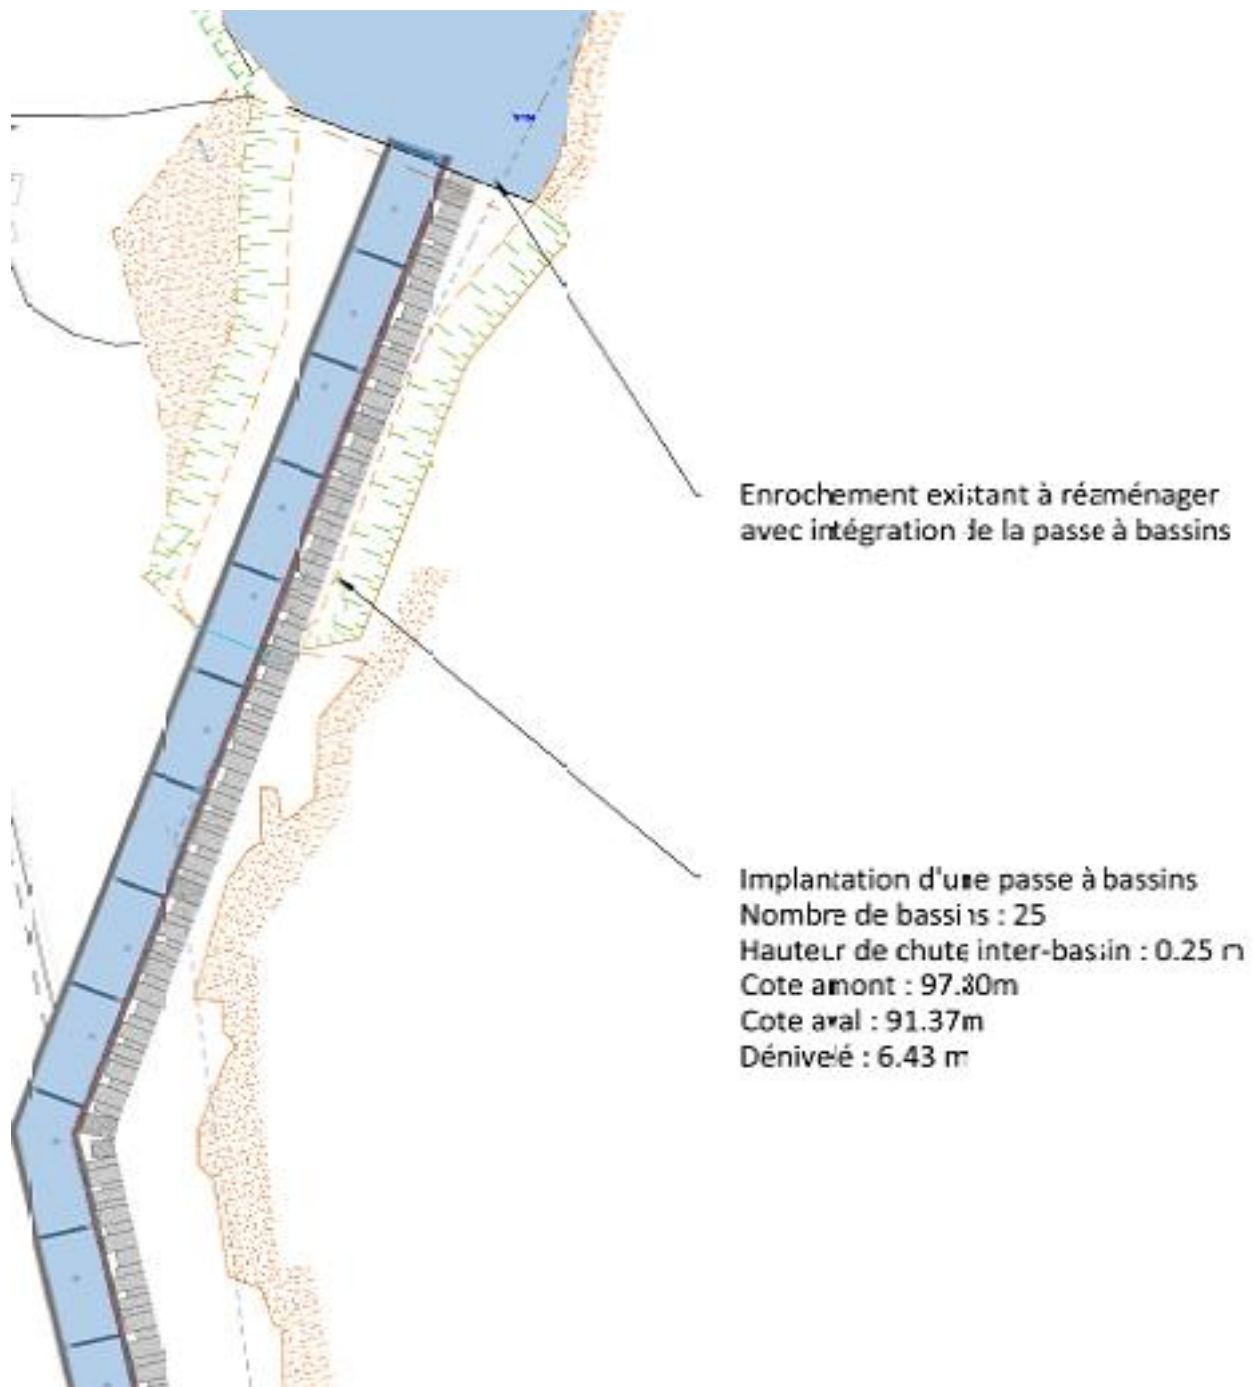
vue en plan de la passe à bassin (secteur 3)
